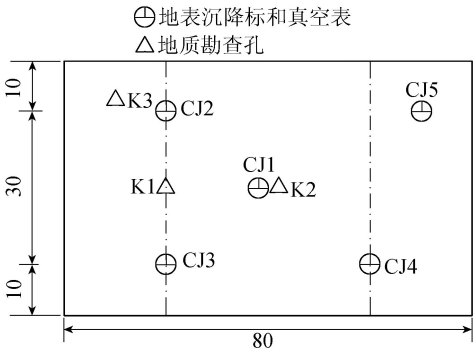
软土地基沉降标和地质勘察孔布置平面示意图(单位:m)
